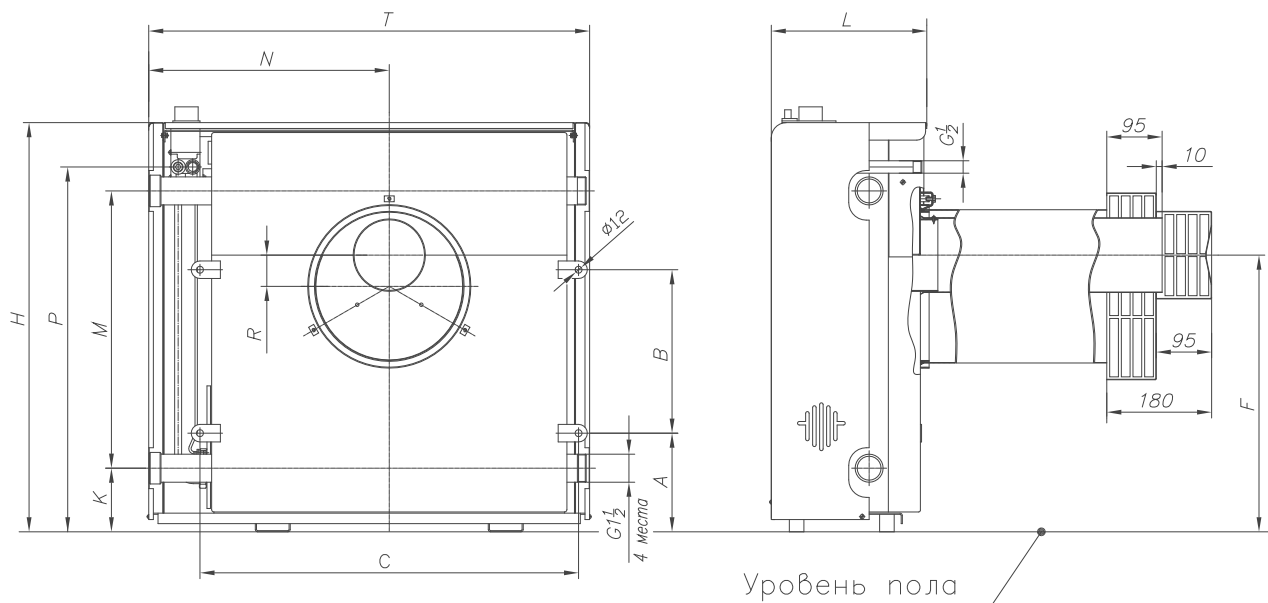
Основные присоединительные и монтажные размеры аппарата (котла)
